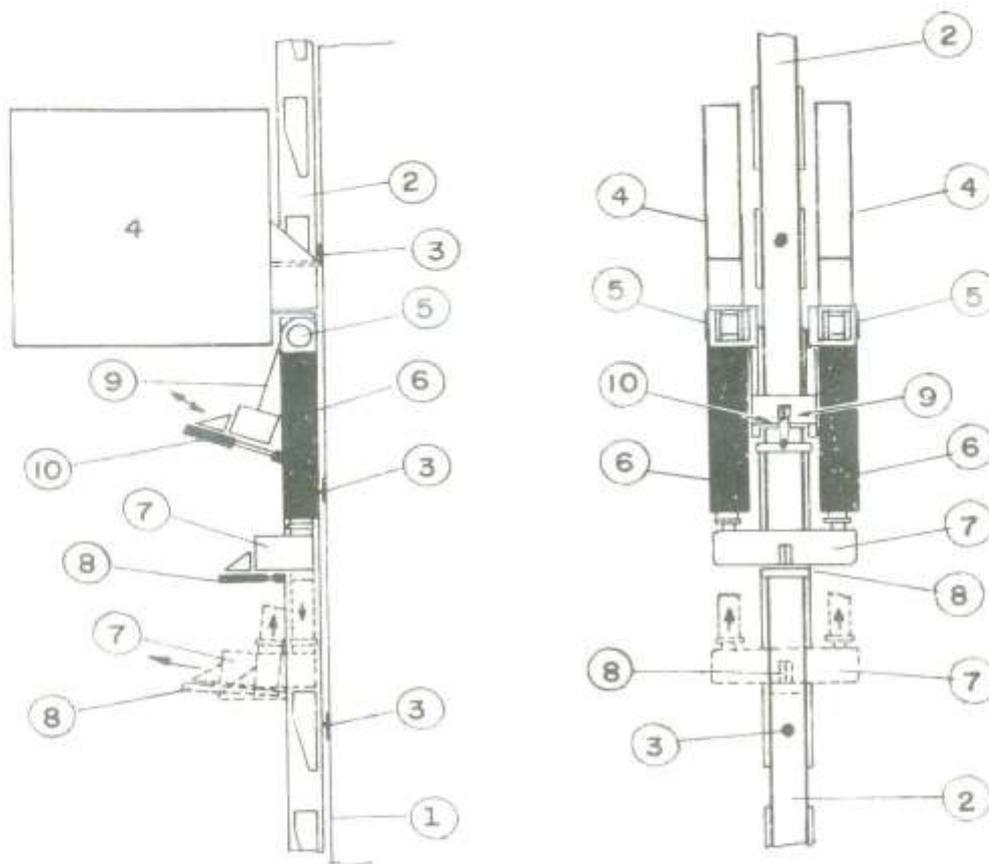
Dispositivo hidráulico de elevação das estruturas metálicas:
